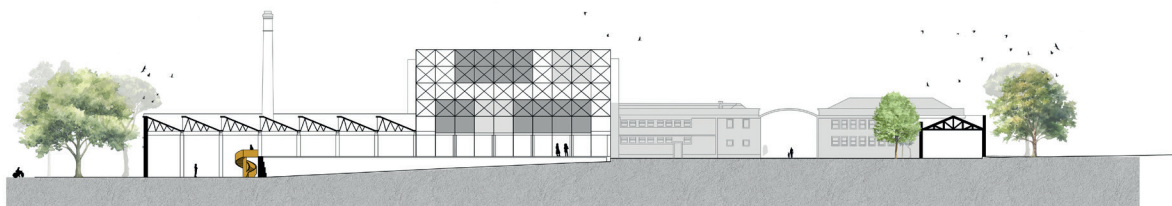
Corte transversal ponte, da Fábrica Barros. Realizado no CAD pela autora.
